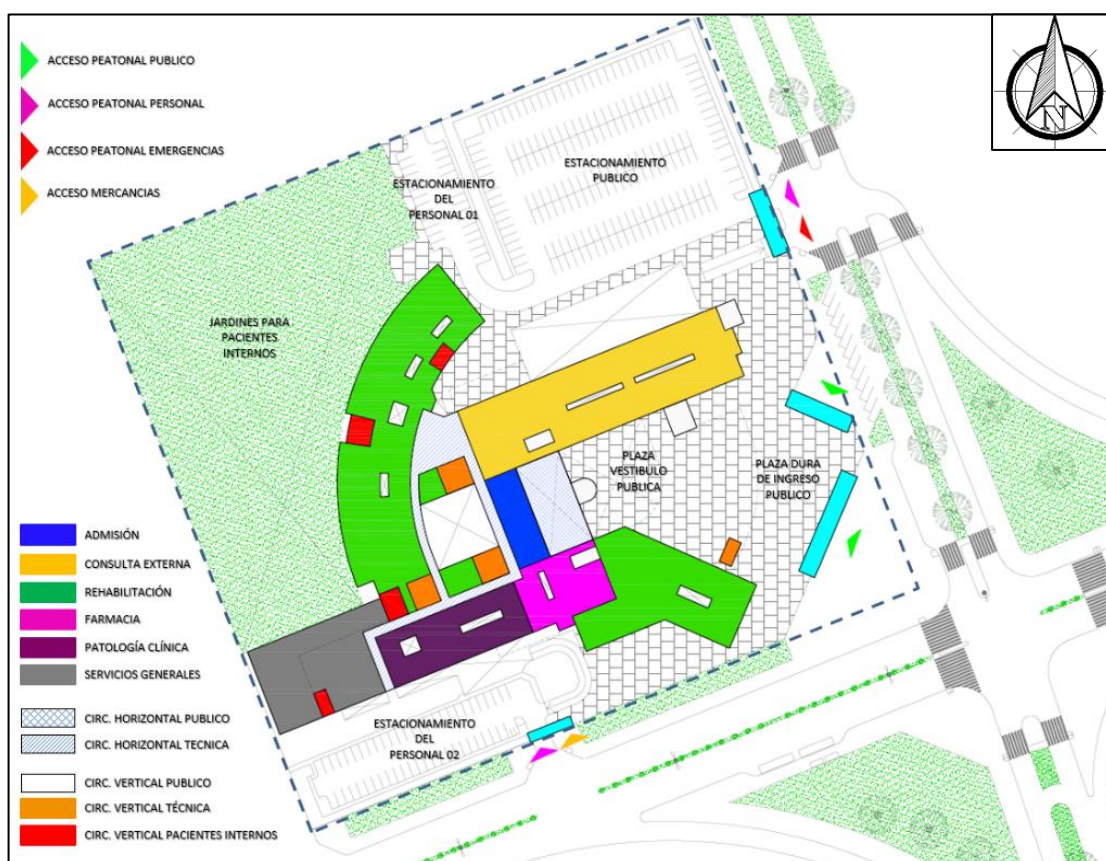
Planimetría del funcionamiento de la planta baja del proyecto.
